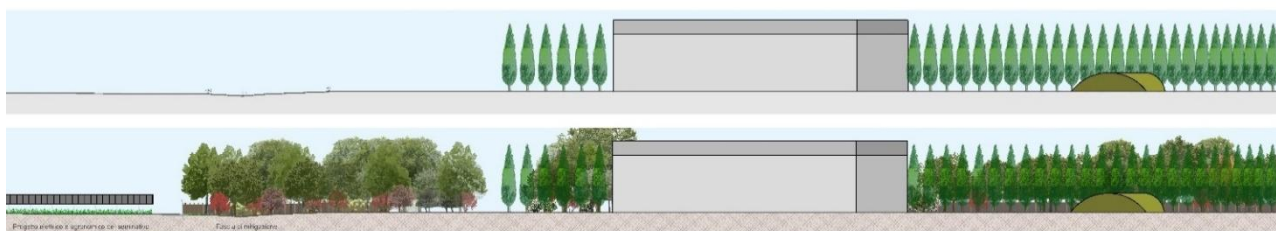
Sezione I-I' scala 1:500 dalla Tavola C03 _Sezione di approfondimento sui beni tutelati
